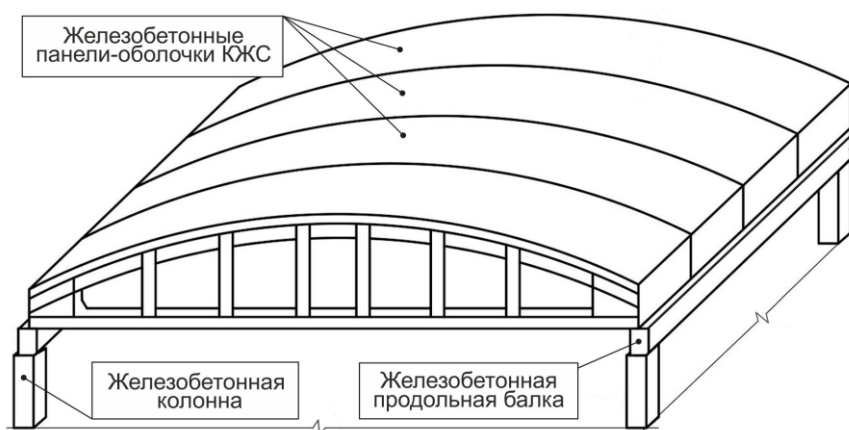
Железобетонное покрытие цеха пролетом 18 м из панелей-оболочек марки КЖС
